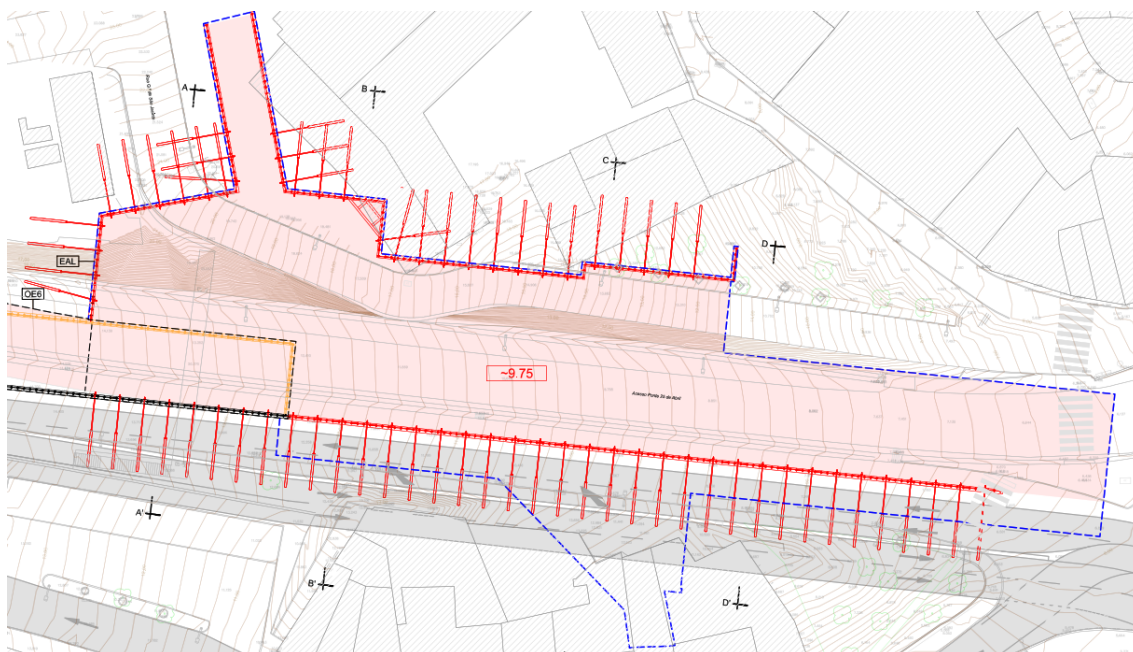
Planta de Dimensionamento Contenção Provisória – 1ª Fase de escavação
